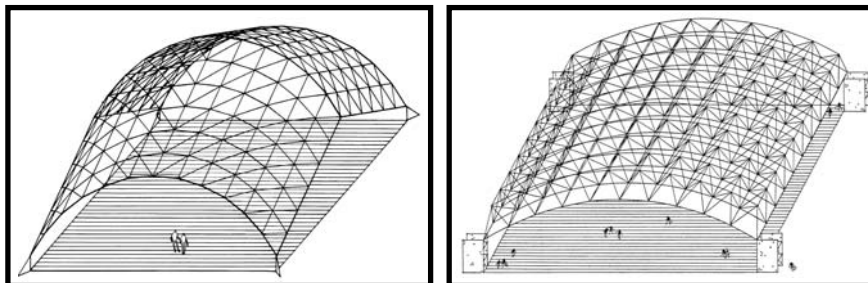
Bogen in Fachwerkbauweise für große Abmessungen [49]
